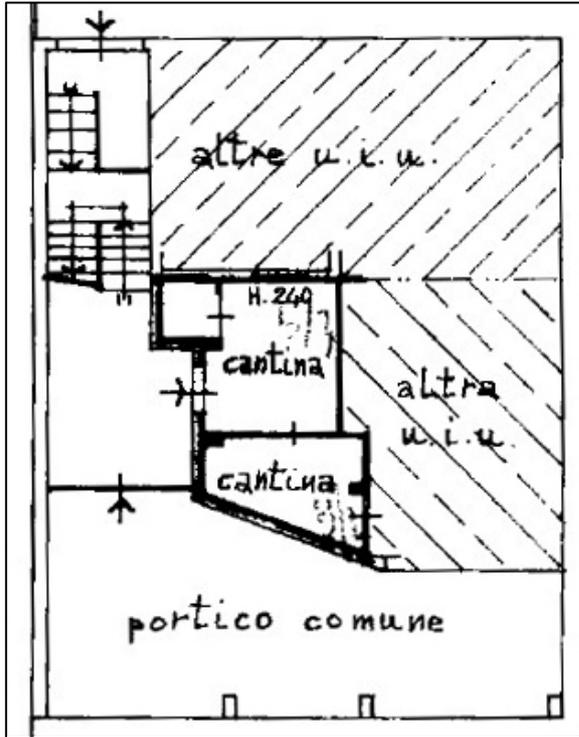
Planimetria catastale del 20.03.1995 Cantina
